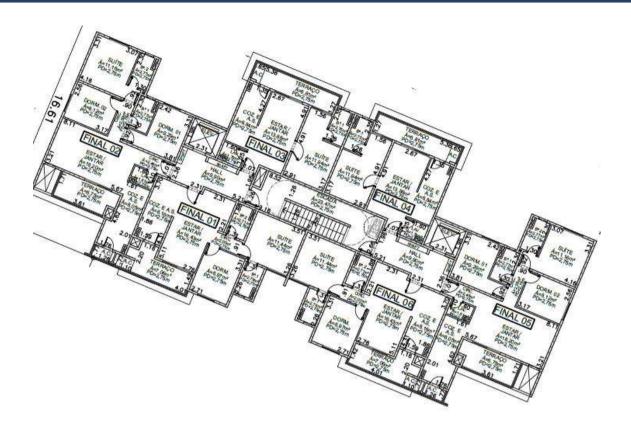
Projeto - Pavimento Tipo. Torres 5 e 6.
